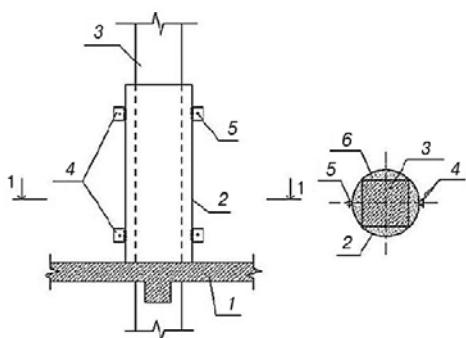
Усиление с помощью комбинированного армирования: 1 – плита перекрытия; 2 – U-образный металлический лоток; 3 – усиливаемая колонна; 4 – фланцы; 5 – болты; 6 – фибробетон
